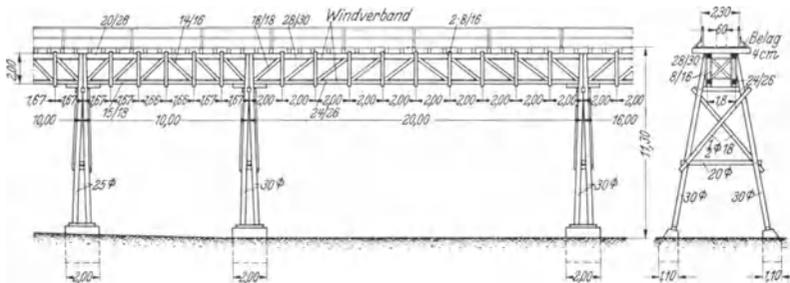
Transportbrücke der Zementfabrik Siegfried, Salzderhelden (Südhanover).
